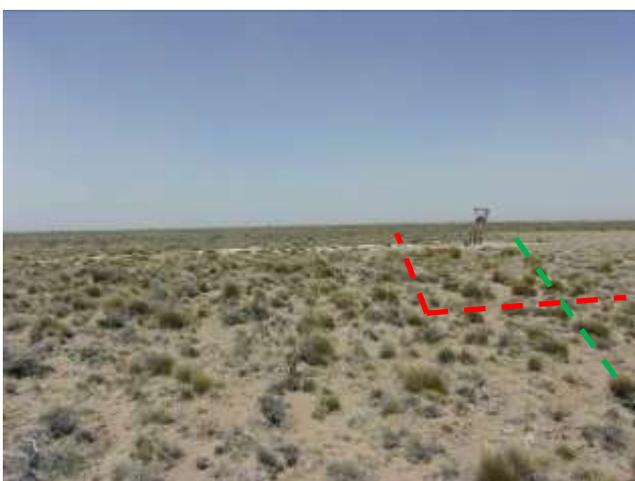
Vértice SO de la locación existente (verde) y vértice SO de locación propuesta (Rojo). Interfiere camino de acceso. Foto en dirección S.
